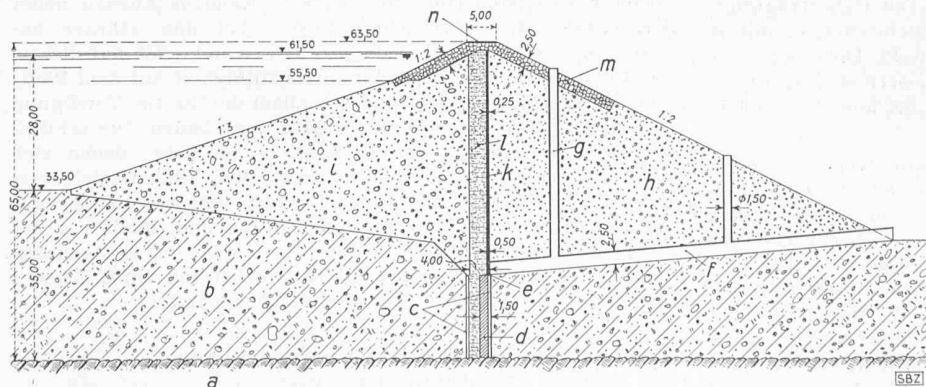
Erddamm, gebaut 1948, Masstab 1:1500. a Granit, b Alluvion, c Spundwand, d Beton, e Gelenk mit Bitumenzwischenlage, f Revisionsstollen, g Revisionschacht, h Kies, i Kies und Steine, k Eisenbetonplatte, l Lehm und Sand, m Steinrollierung, n Strassenkoffer
